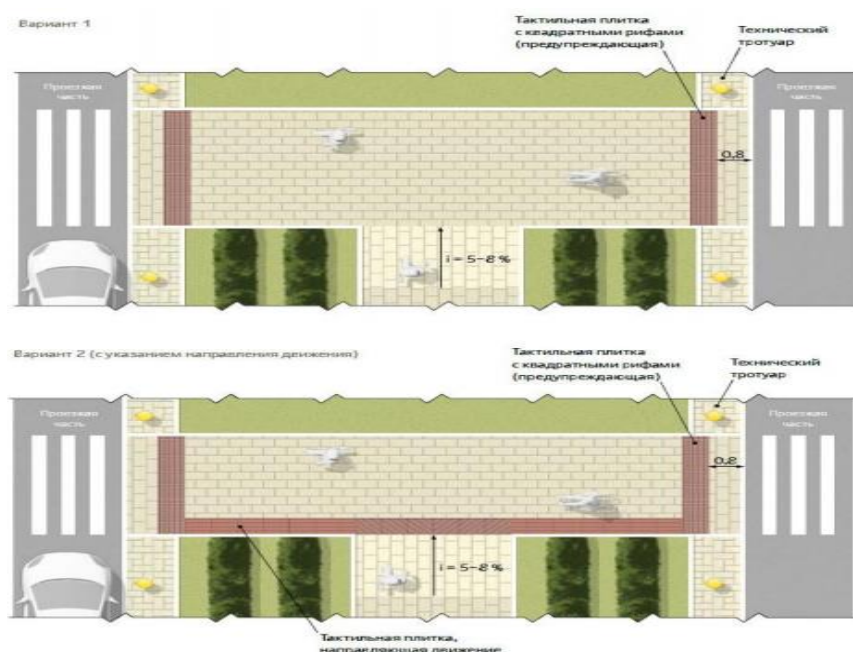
Размещение тактильных плит на пешеходных тротуарах, расположенных на уровне проезжей части (вариант 1,2)
